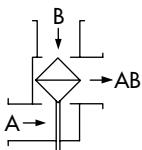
Einbaubeispiel Typ 9 (Anlagenschema mit Wärmetauscher) · Fühlereinbau
